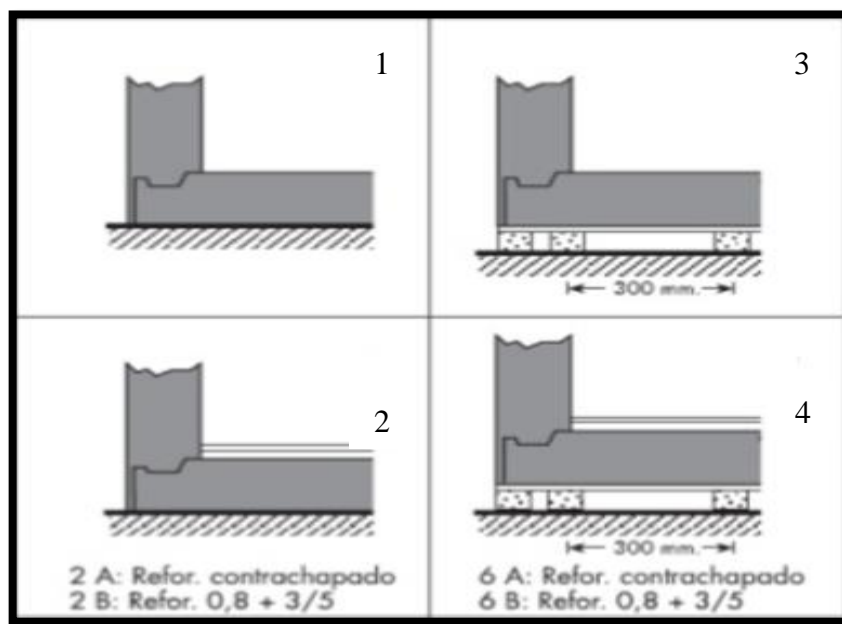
Detalhe da instalação de câmaras com painel de solo (Muoz, 2010)
